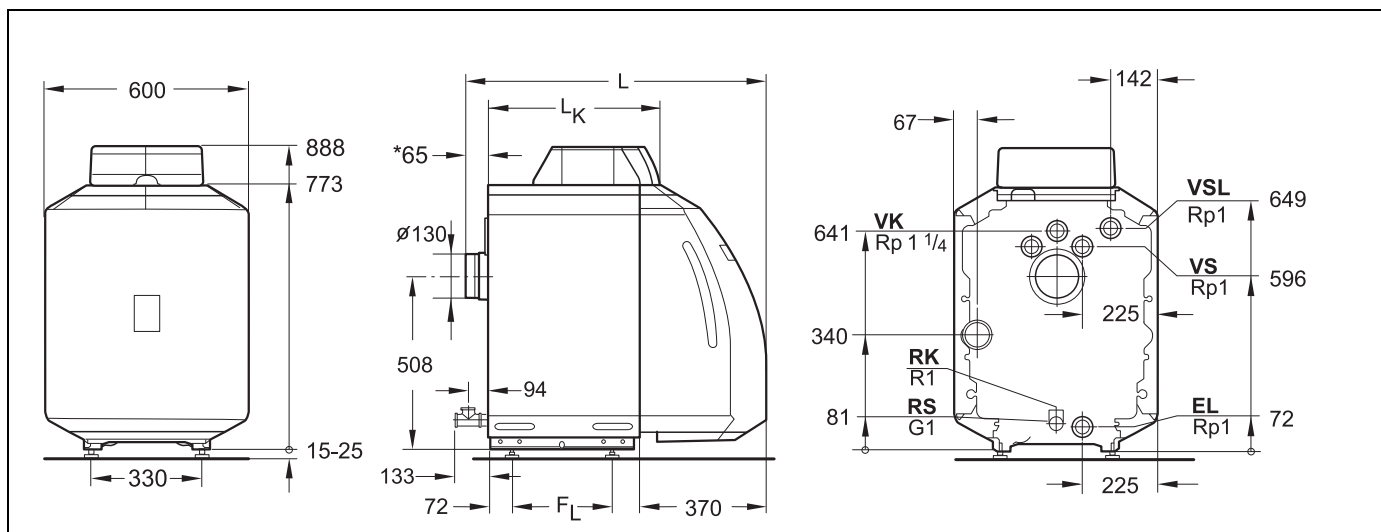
Conexiones y dimensiones (dimensiones en mm)
